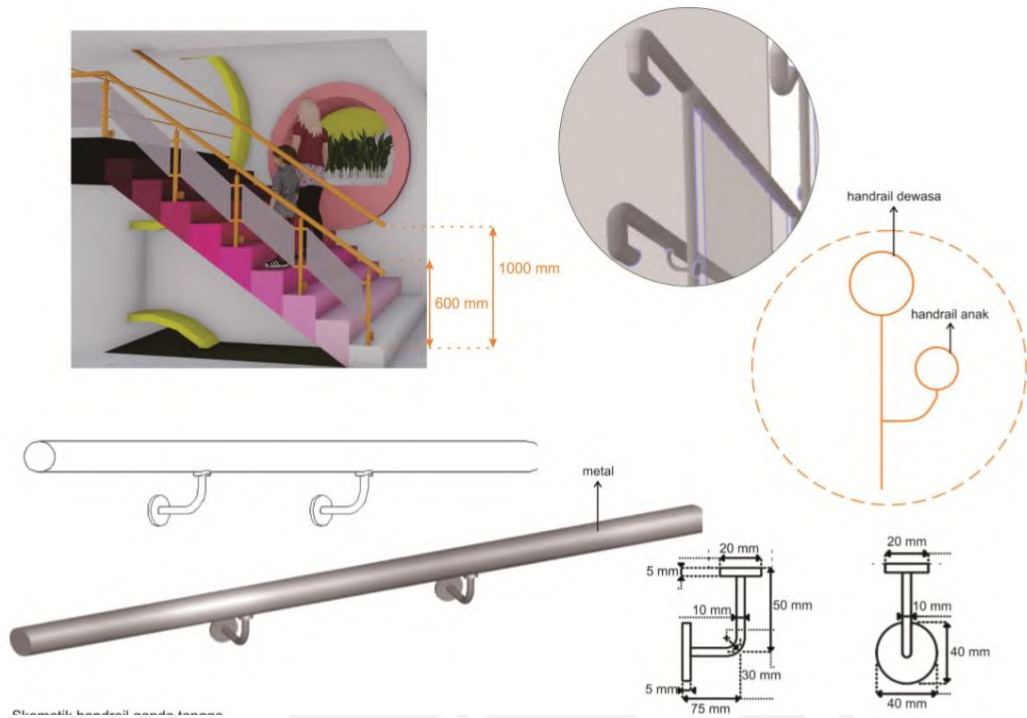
Akses Difabel & Keselamatan Bangunan Second Floor
